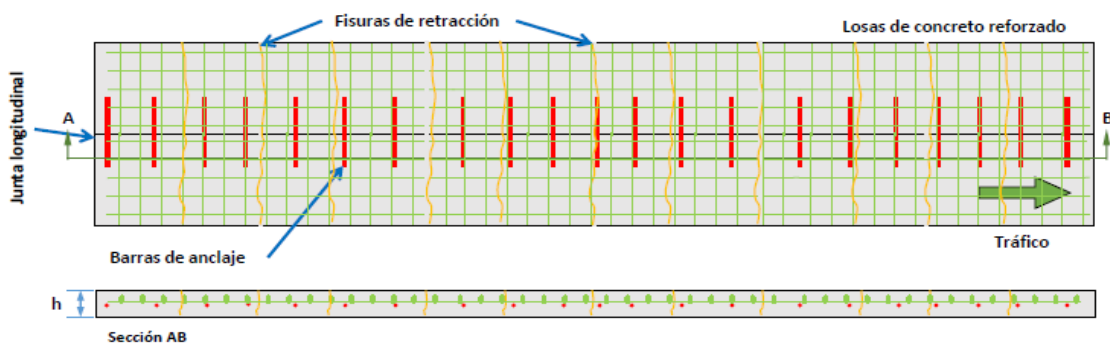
Pavimento de concreto continuamente reforzado, por Vásquez, 2017.
